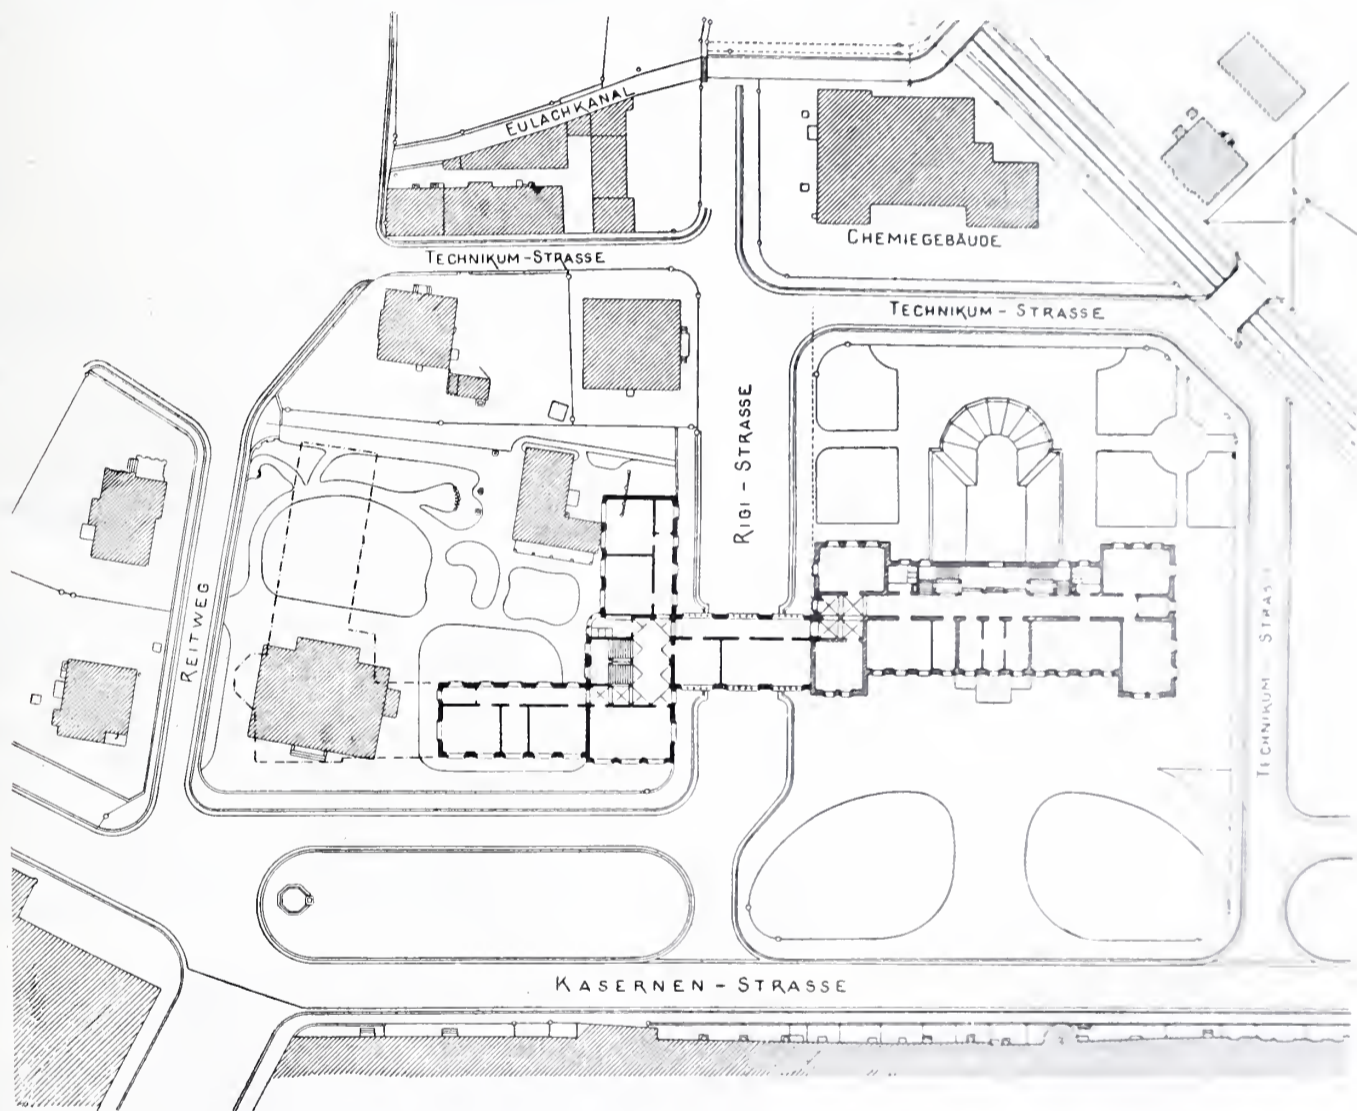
Lageplan und Grundriss vom Obergeschoss. — Masstab 1:1500.
